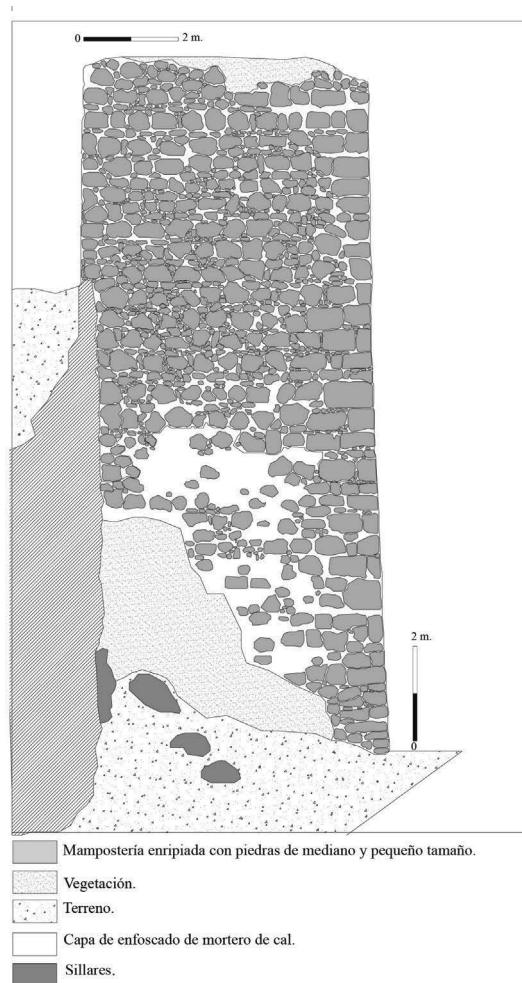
Torre 9 en su cara oeste. El segundo cinturón de las murallas. La técnica constructiva es mampostería enripiada con refuerzo de sillaría en sus esquinas.
